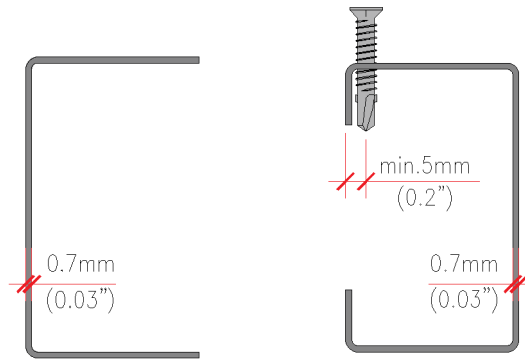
Secção tipo de estrutura em aço galvanizado
